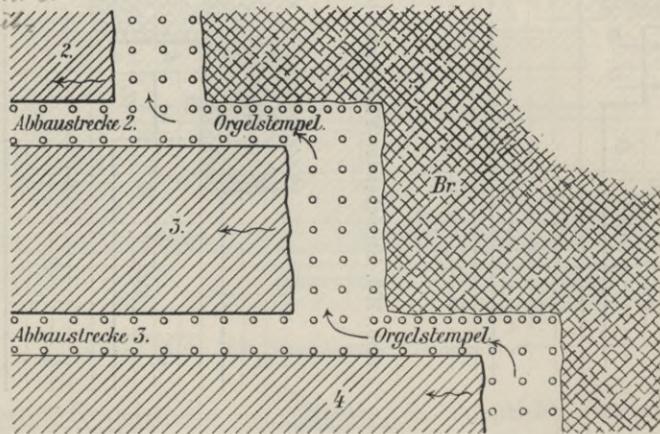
Ausbau beim streichenden Pfeilerbruchbau.
